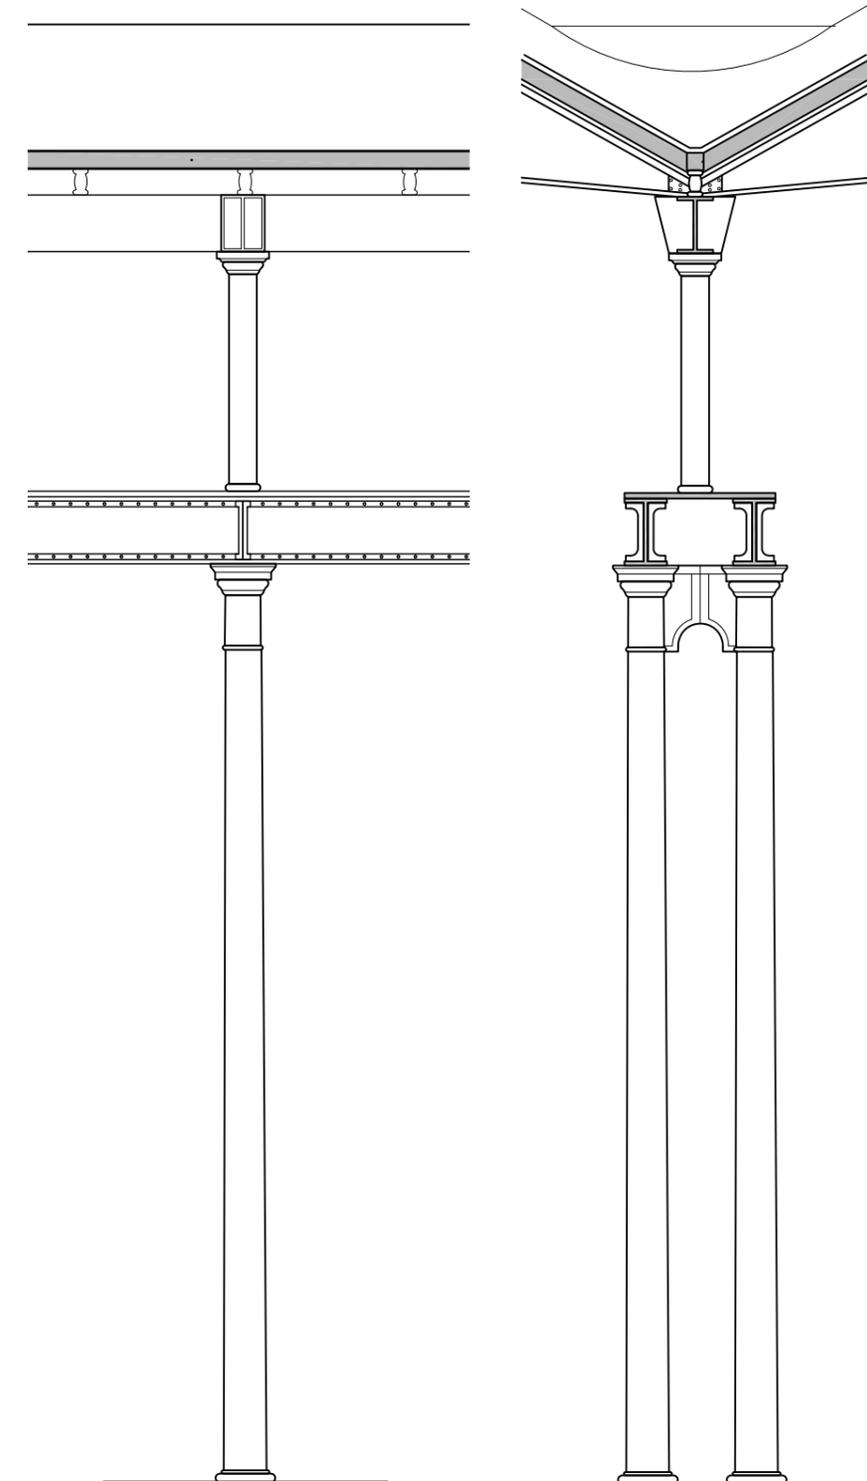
Längsschnitt (links) und Querschnitt (rechts) der Stützen im Maschinenraum Maßstab 1:50
